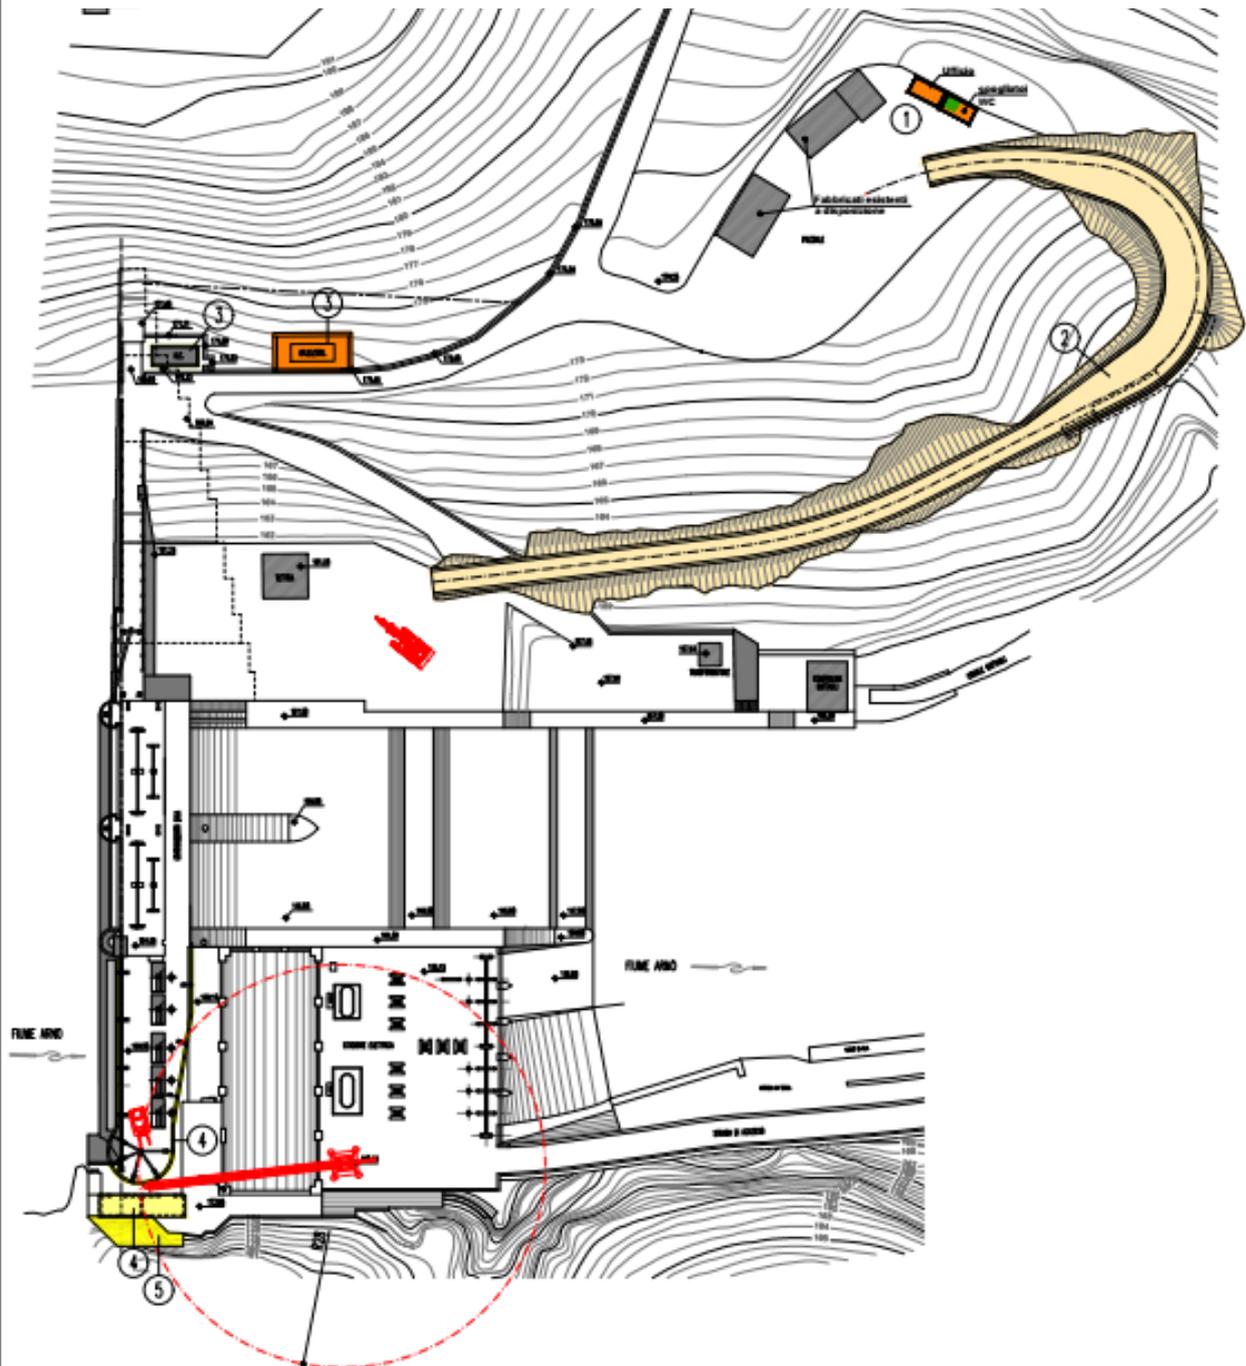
1 – Estratto planimetrico progettuale – Cantierizzazione FASE1
